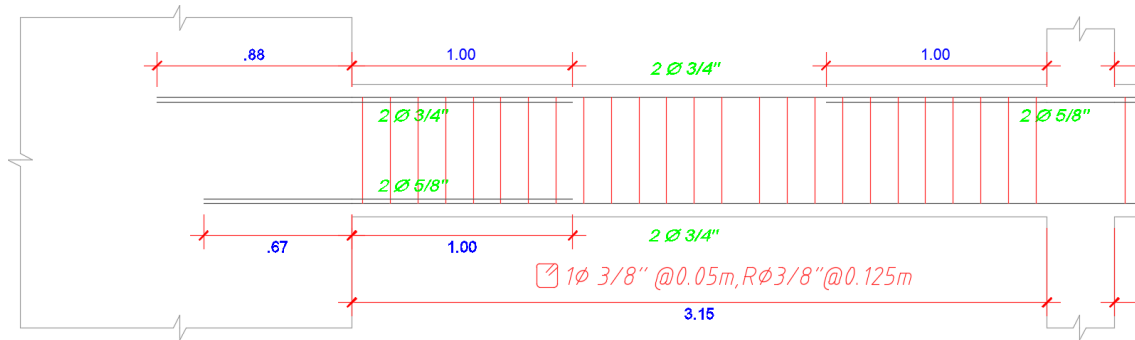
Disposición de estribos final y zona de confinamiento para el tramo 1 de la viga V-101 en el software AutoCAD.
